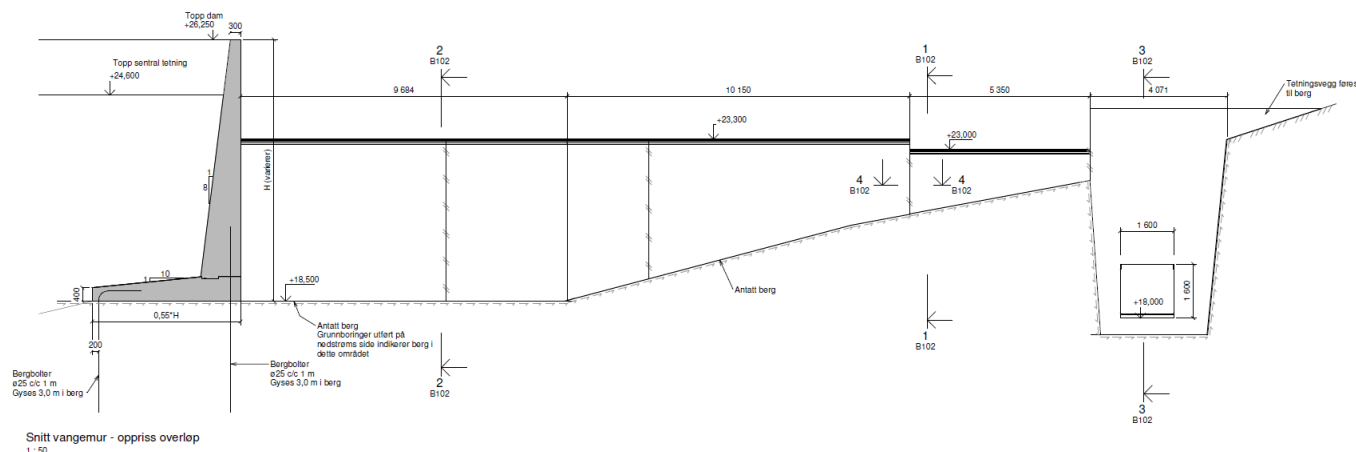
Lengdesnitt av planlagt fyllingsdam.
